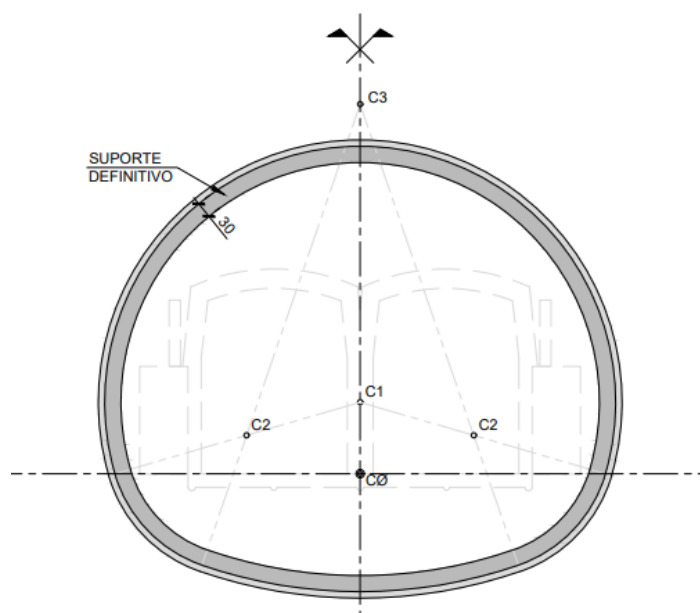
Secção Tipo do túnel de via a construir (revestimento secundário)
